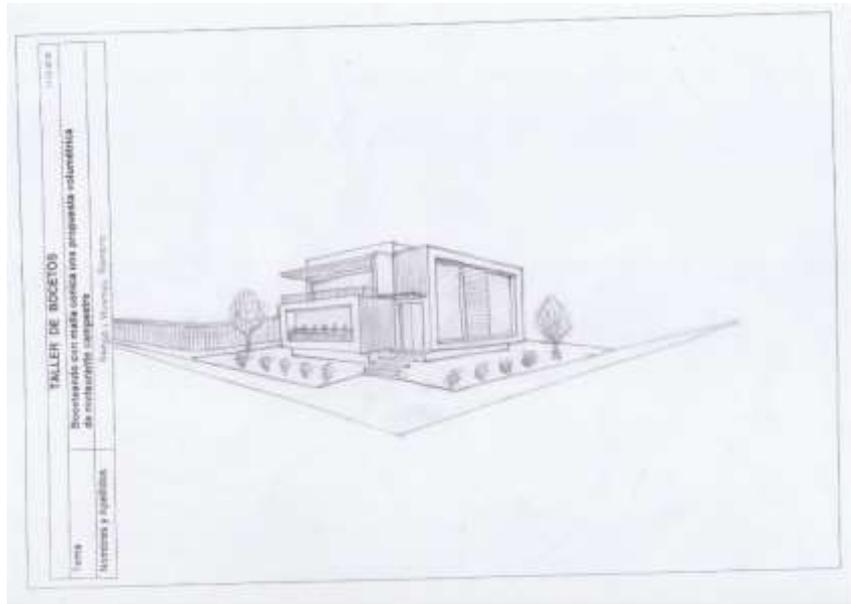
Propuesta de Restaurante Campestre con trama cónica
